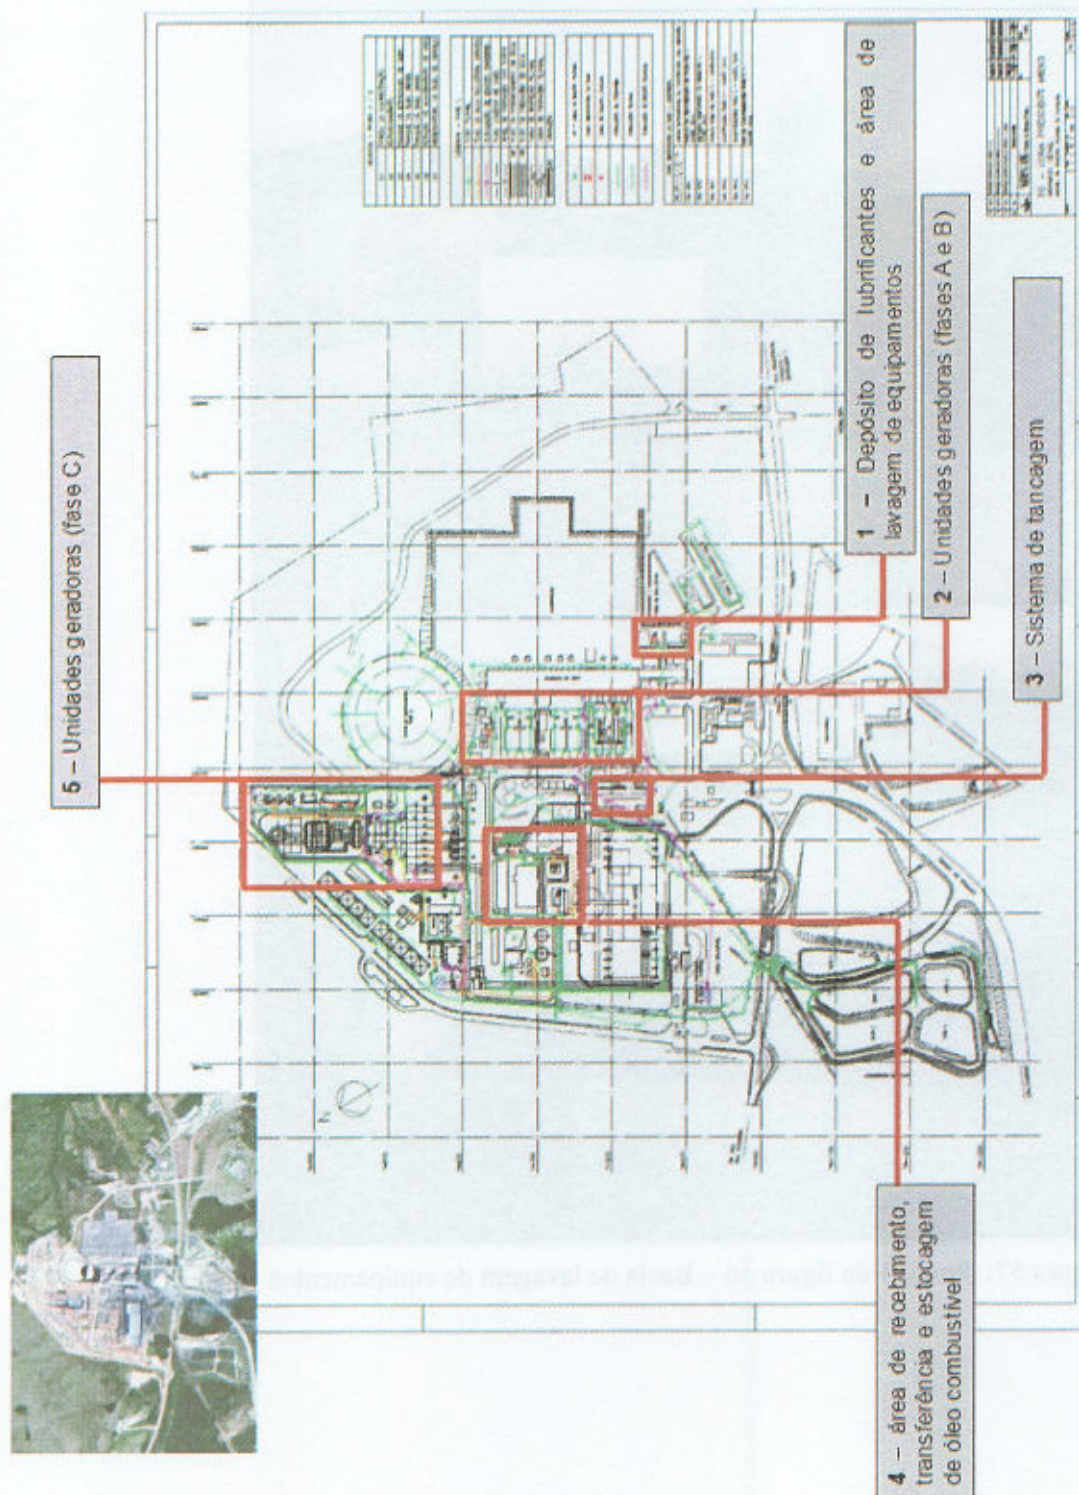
Planta de arranjo geral do complexo e identificação dos pontos vistoriados
